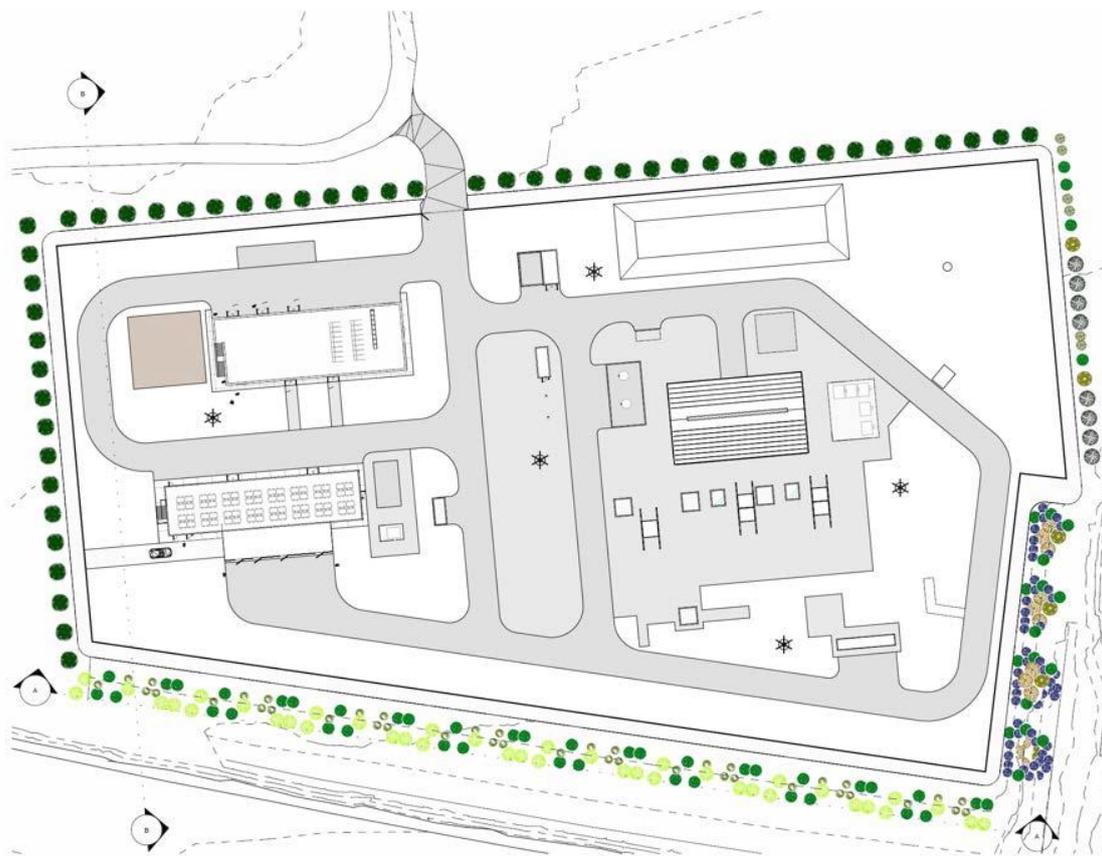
Stralcio planimetrico del progetto di inserimento paesaggistico con la dislocazione delle piante
